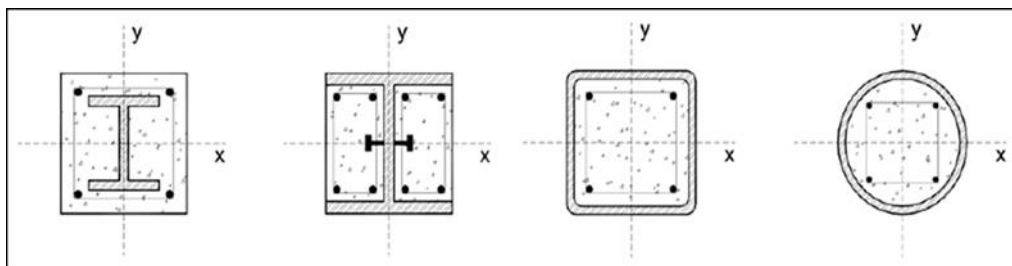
Seção transversais de pilares mistos de aço e concreto previstas.
